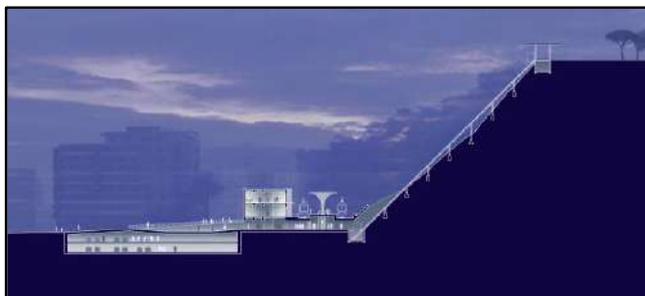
Sezione longitudinale stazione/ascensore inclinato
